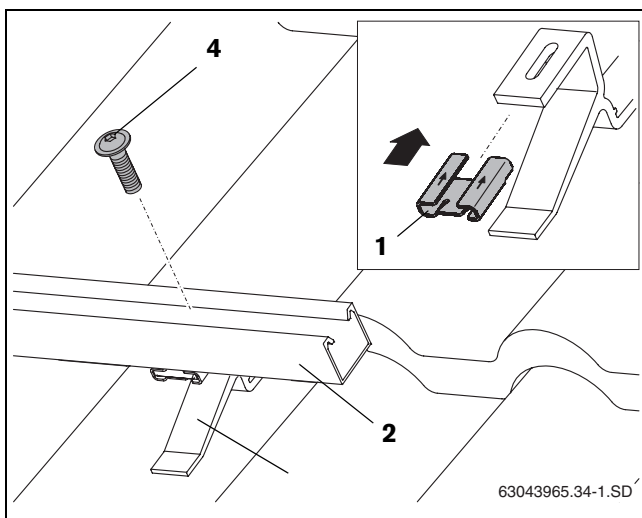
Fijación de los perfiles guía a los ganchos de tejado
